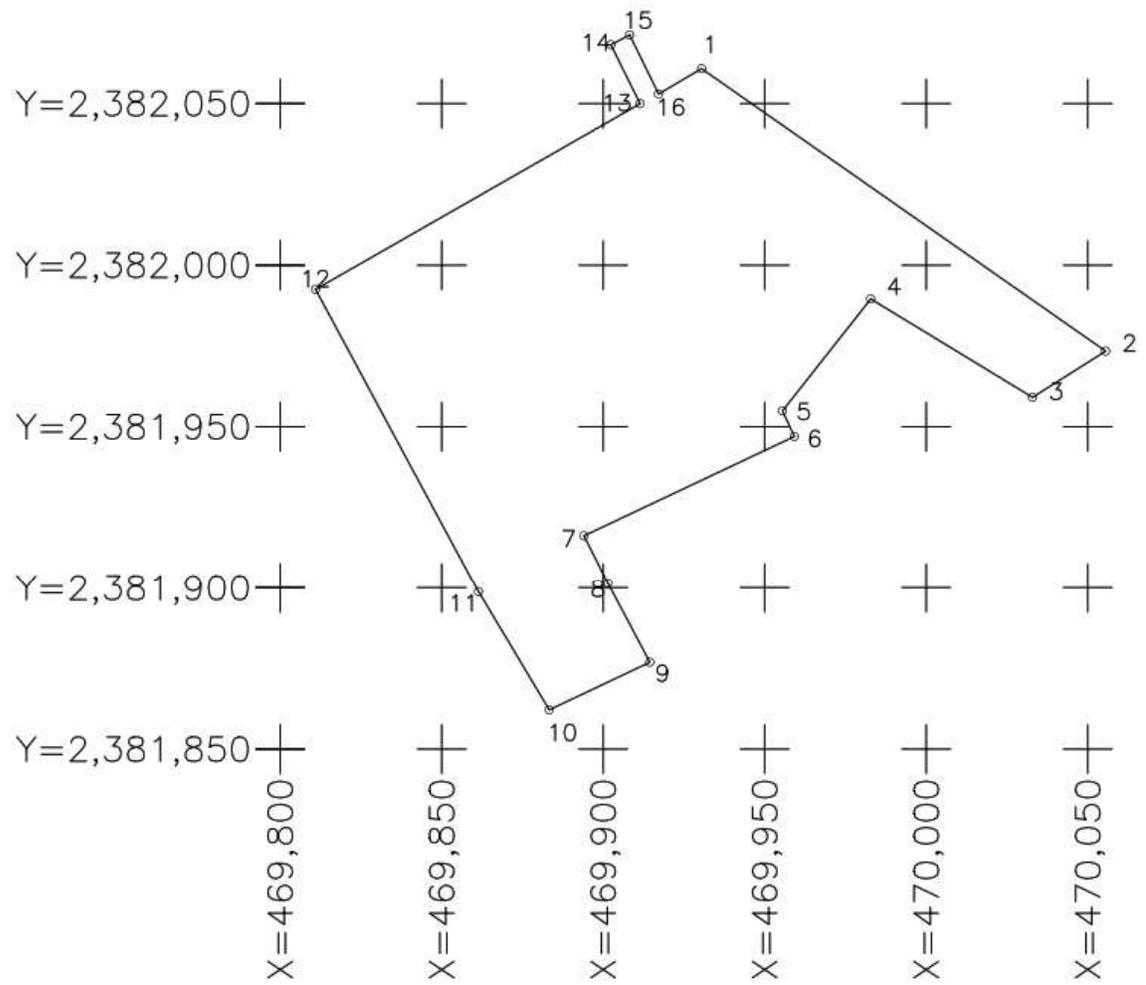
Plano del sitio del proyecto (Georeferenciado).
